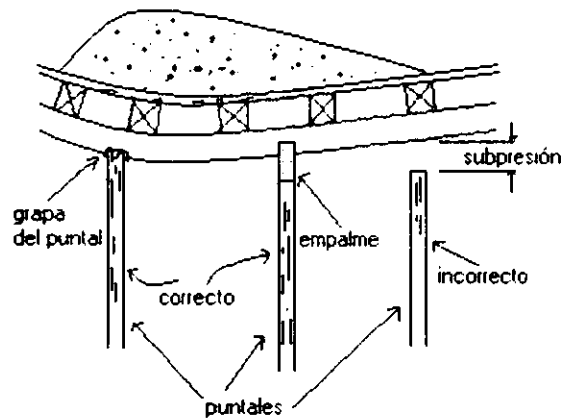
Subpresión en la cimbra. La conexión de los puntales a los largueros y travesaños deben mantener los puntales en su lugar cuando ocurra la torsión o la subpresión, para reducir la relación de esbeltez pueden ser necesarios en ambas direcciones los apuntalamientos y refuerzos.
